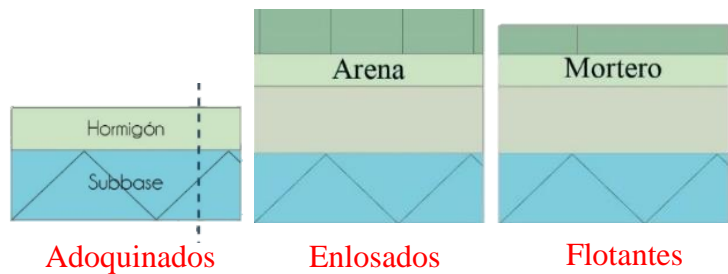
Pavimentos y encintados. Pavimentos exteriores, Pavimentos de piezas. Elaboración propia.
